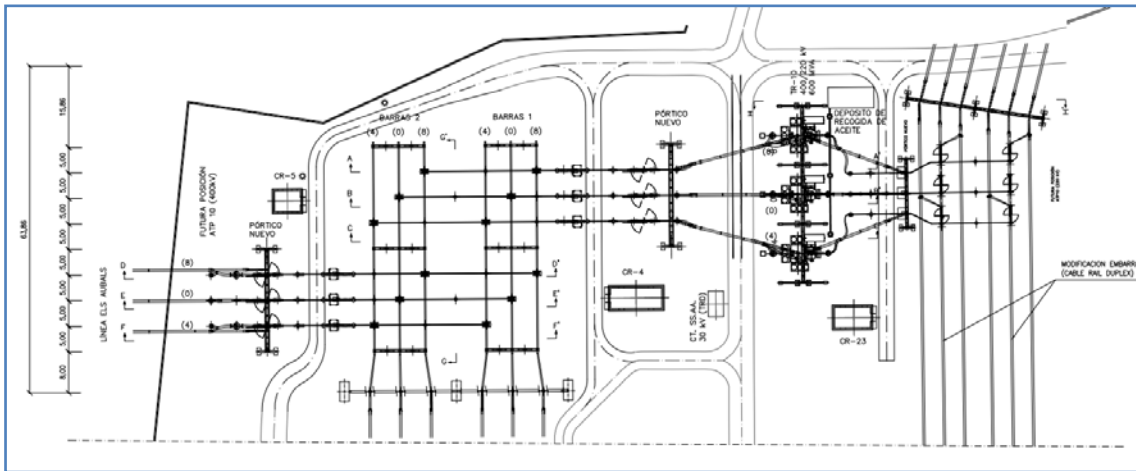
Detalle del proyecto constructivo de la ampliación de la SE de Escatrón
